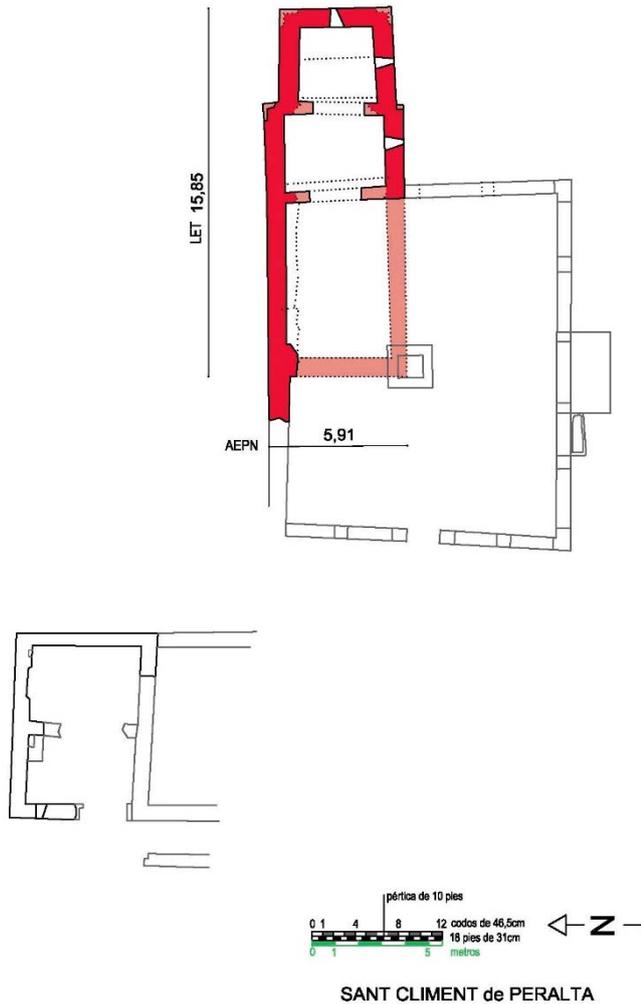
Planta crono-cromática de St. Climent. Elaborada por autora.
